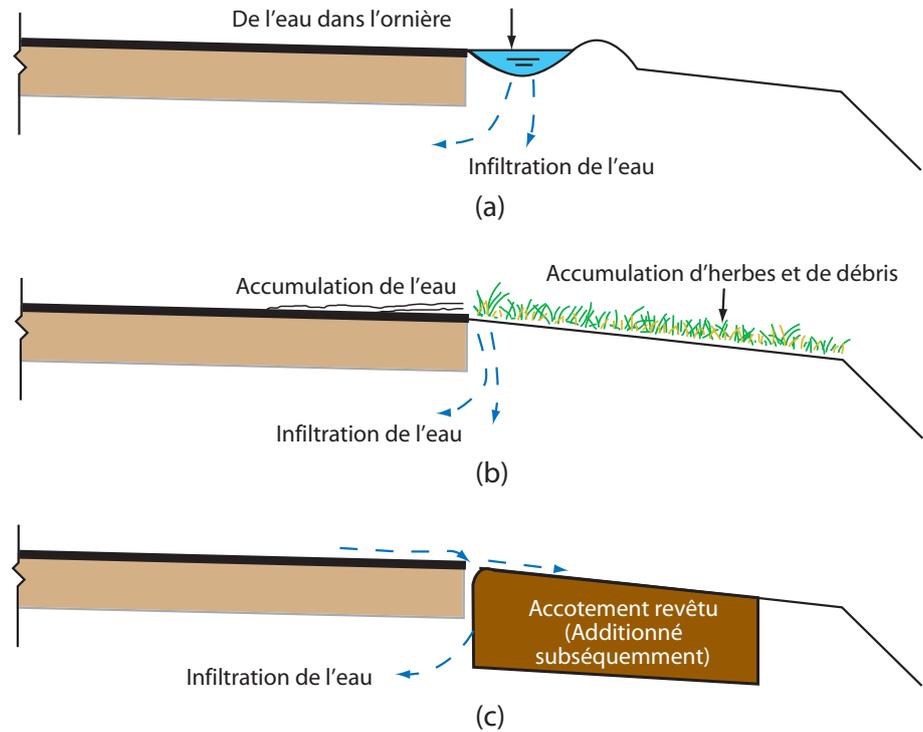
Défauts typiques de drainage associés avec la construction des accotements de chaussée¹³
